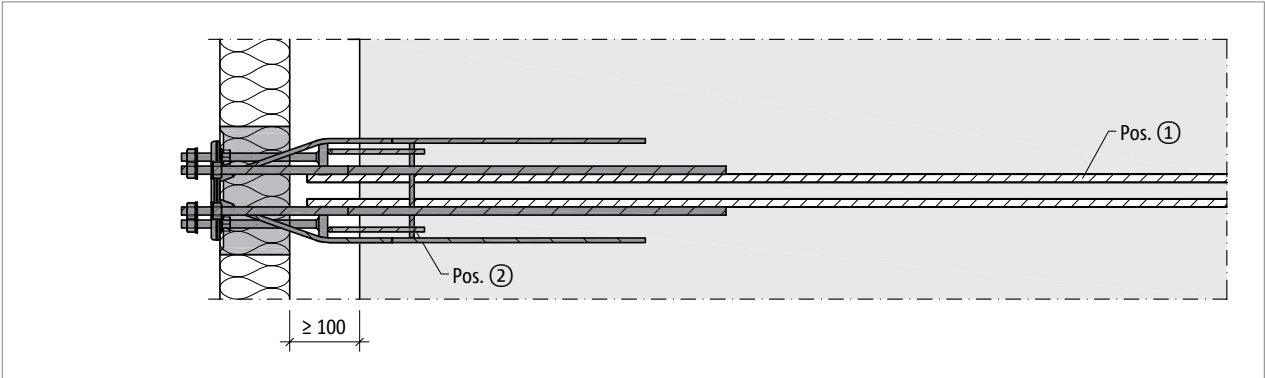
Schöck Isokorb® XT Typ SK-M1: Bauseitige Bewehrung bei Halbfertigteilbauweise, Grundriss
